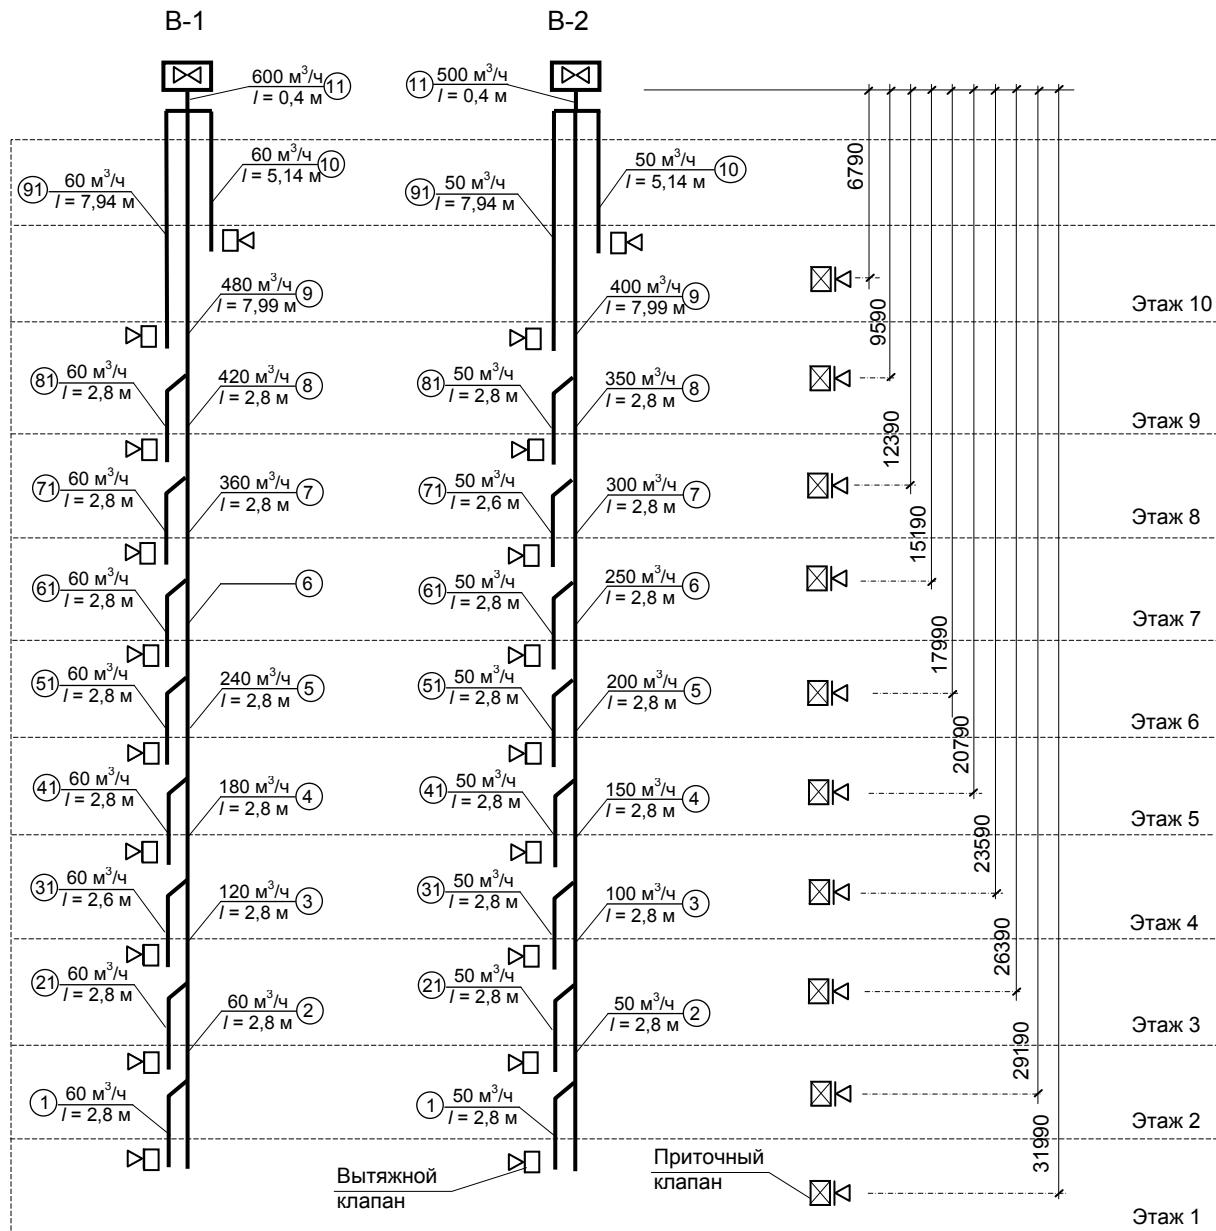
Расчетные схемы систем вентиляции В-1 и В-2
